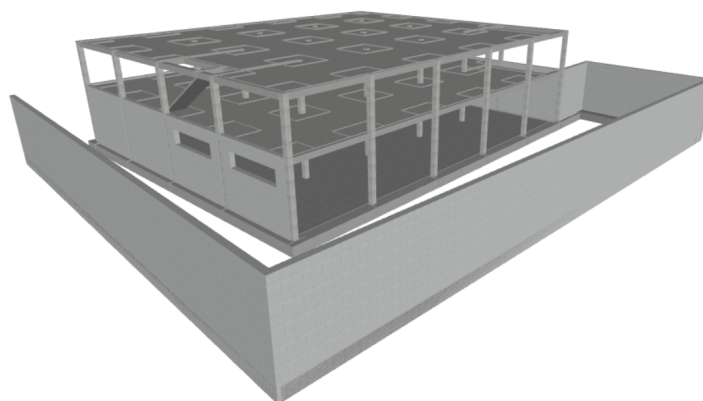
Representación 3D estructura de hormigón armado I. Fuente CYPECAD
